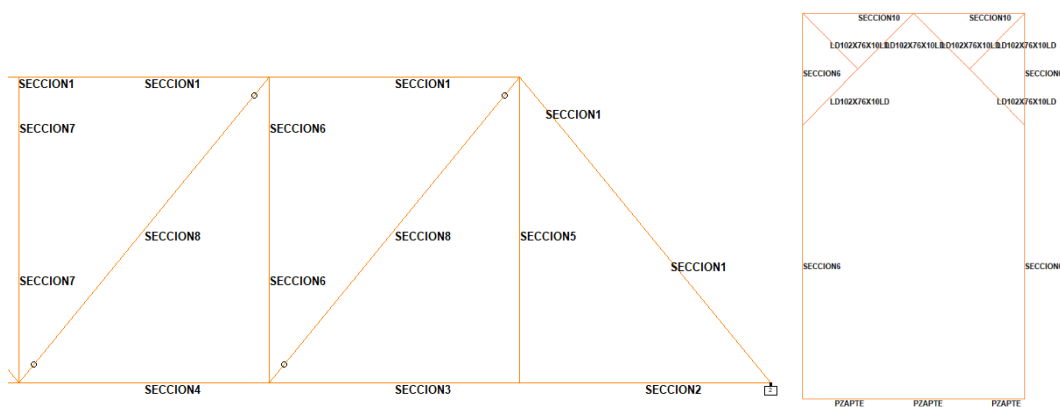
Vista lateral y transversal del modelo de la armadura con secciones (media armadura)
